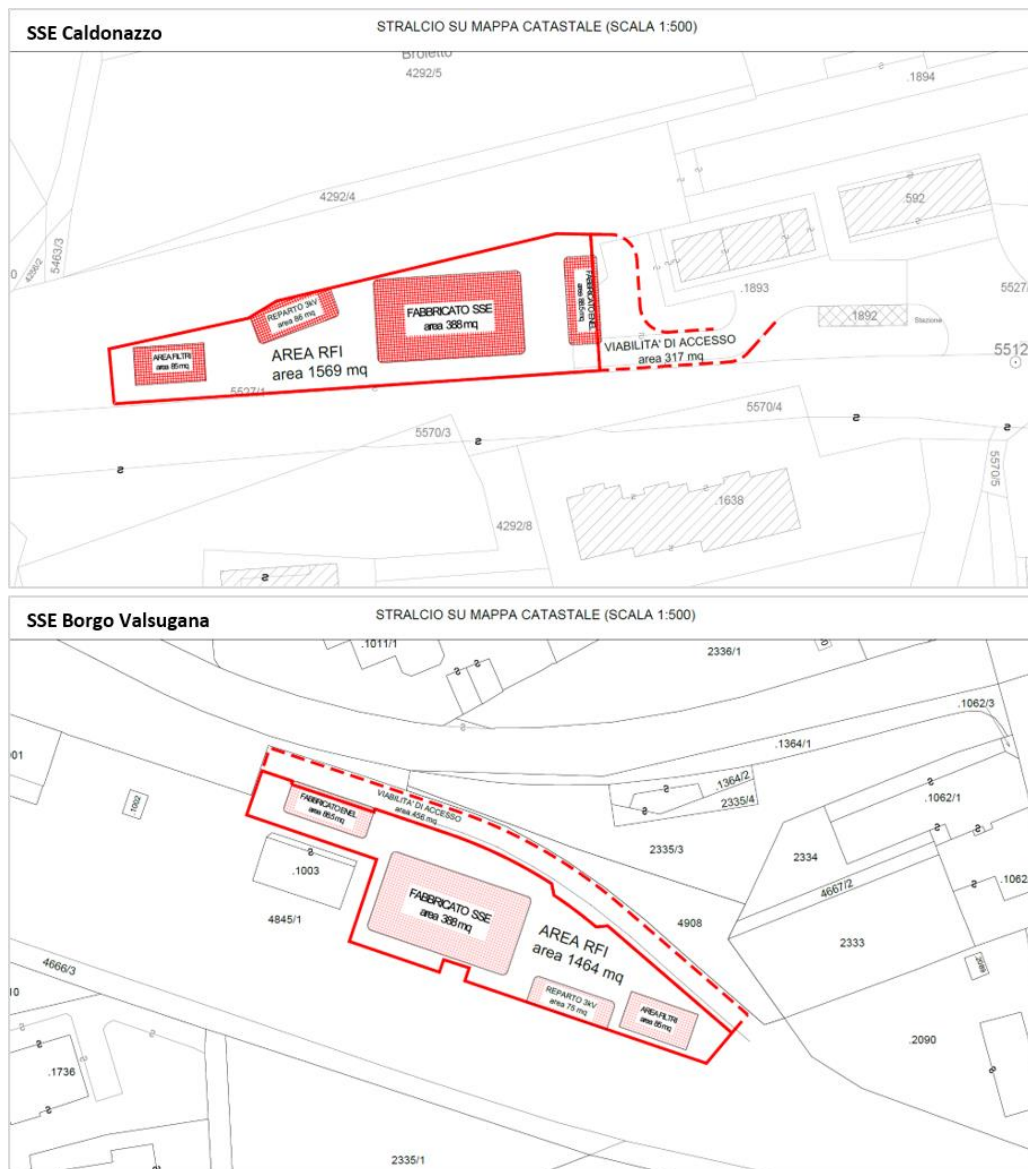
Planimetria di ubicazione impianti nelle SSE di nuova realizzazione
